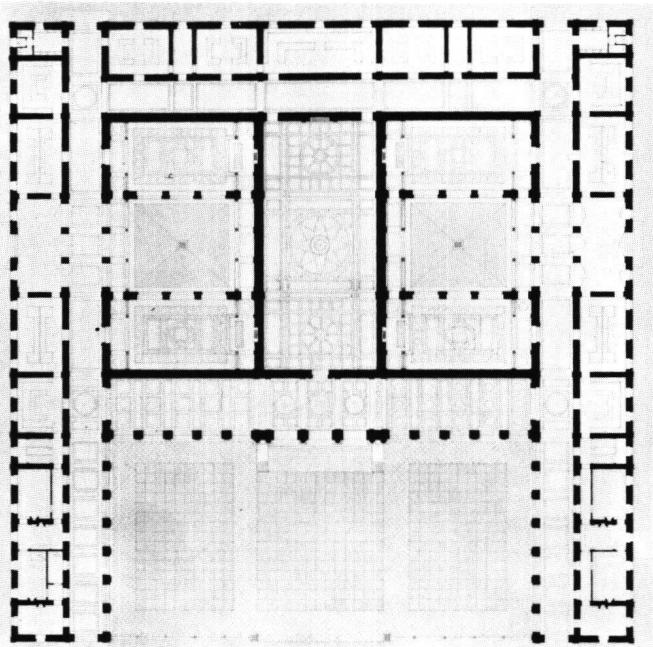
Concours pour une salle de ventes. Plan du rez-de-chaussée, 6 mars 1860.
